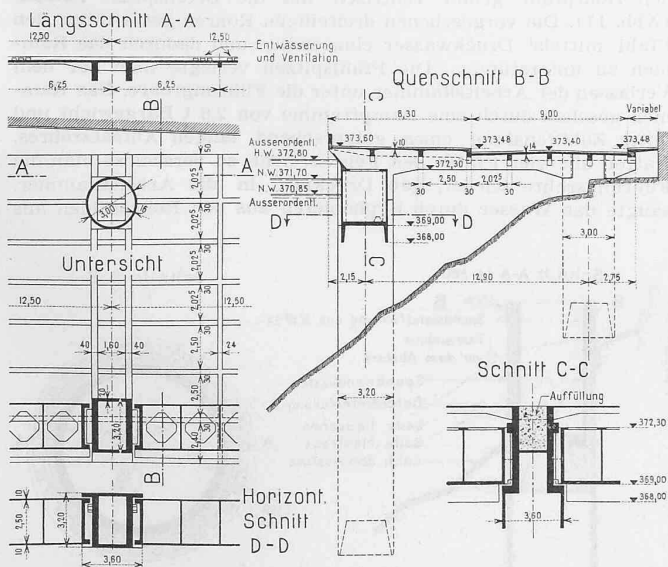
Konstruktive Ausbildung des neuen Quai Perdonnet. Grundriss und Schnitte 1 : 400.
